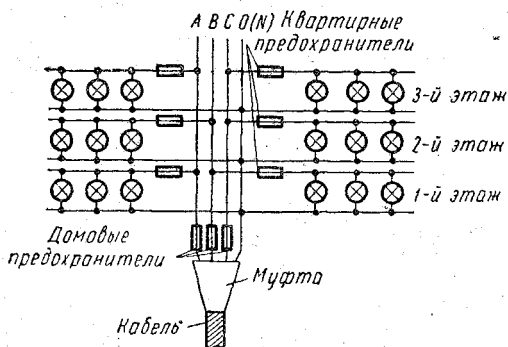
Схема четырехпроводной осветительной сети жилого дома при соединении фаз нагрузки в звезду
